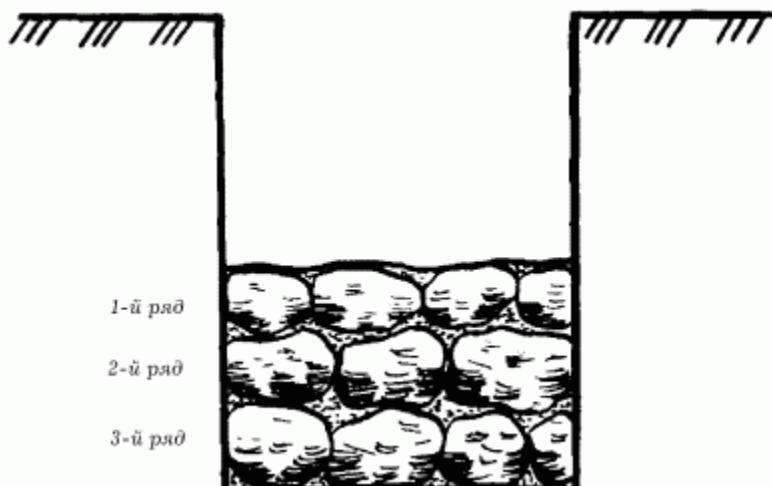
Кладка бутового камня враспор со стенками траншеи.
